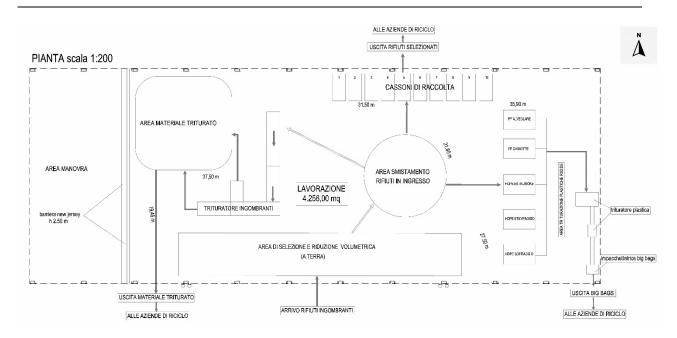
Planimetrie con individuazione dell'area di intervento nello stato attuale e nello stato di progetto
